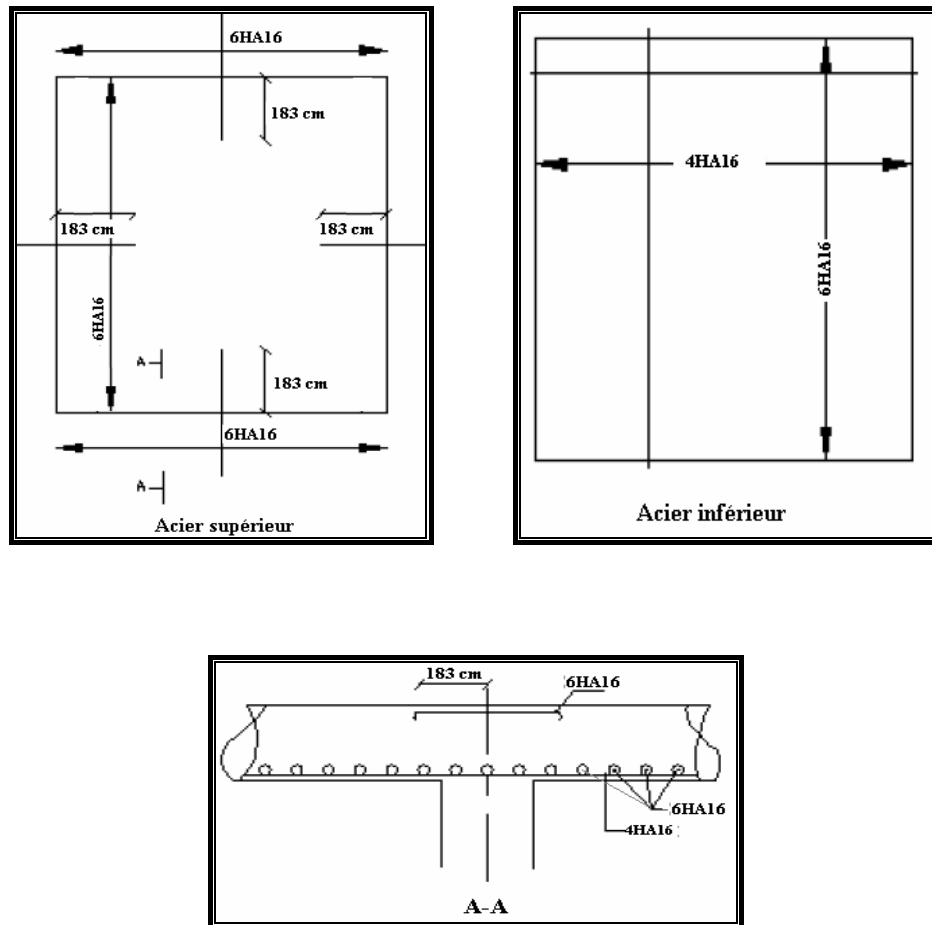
Schéma de ferrailage de la dalle.
